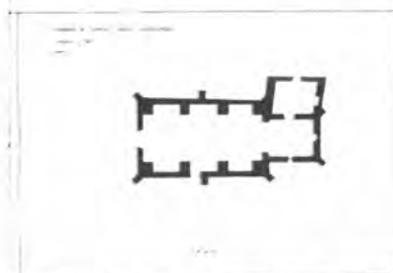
Planta da Igreja de St. Clara (DGEMN)
